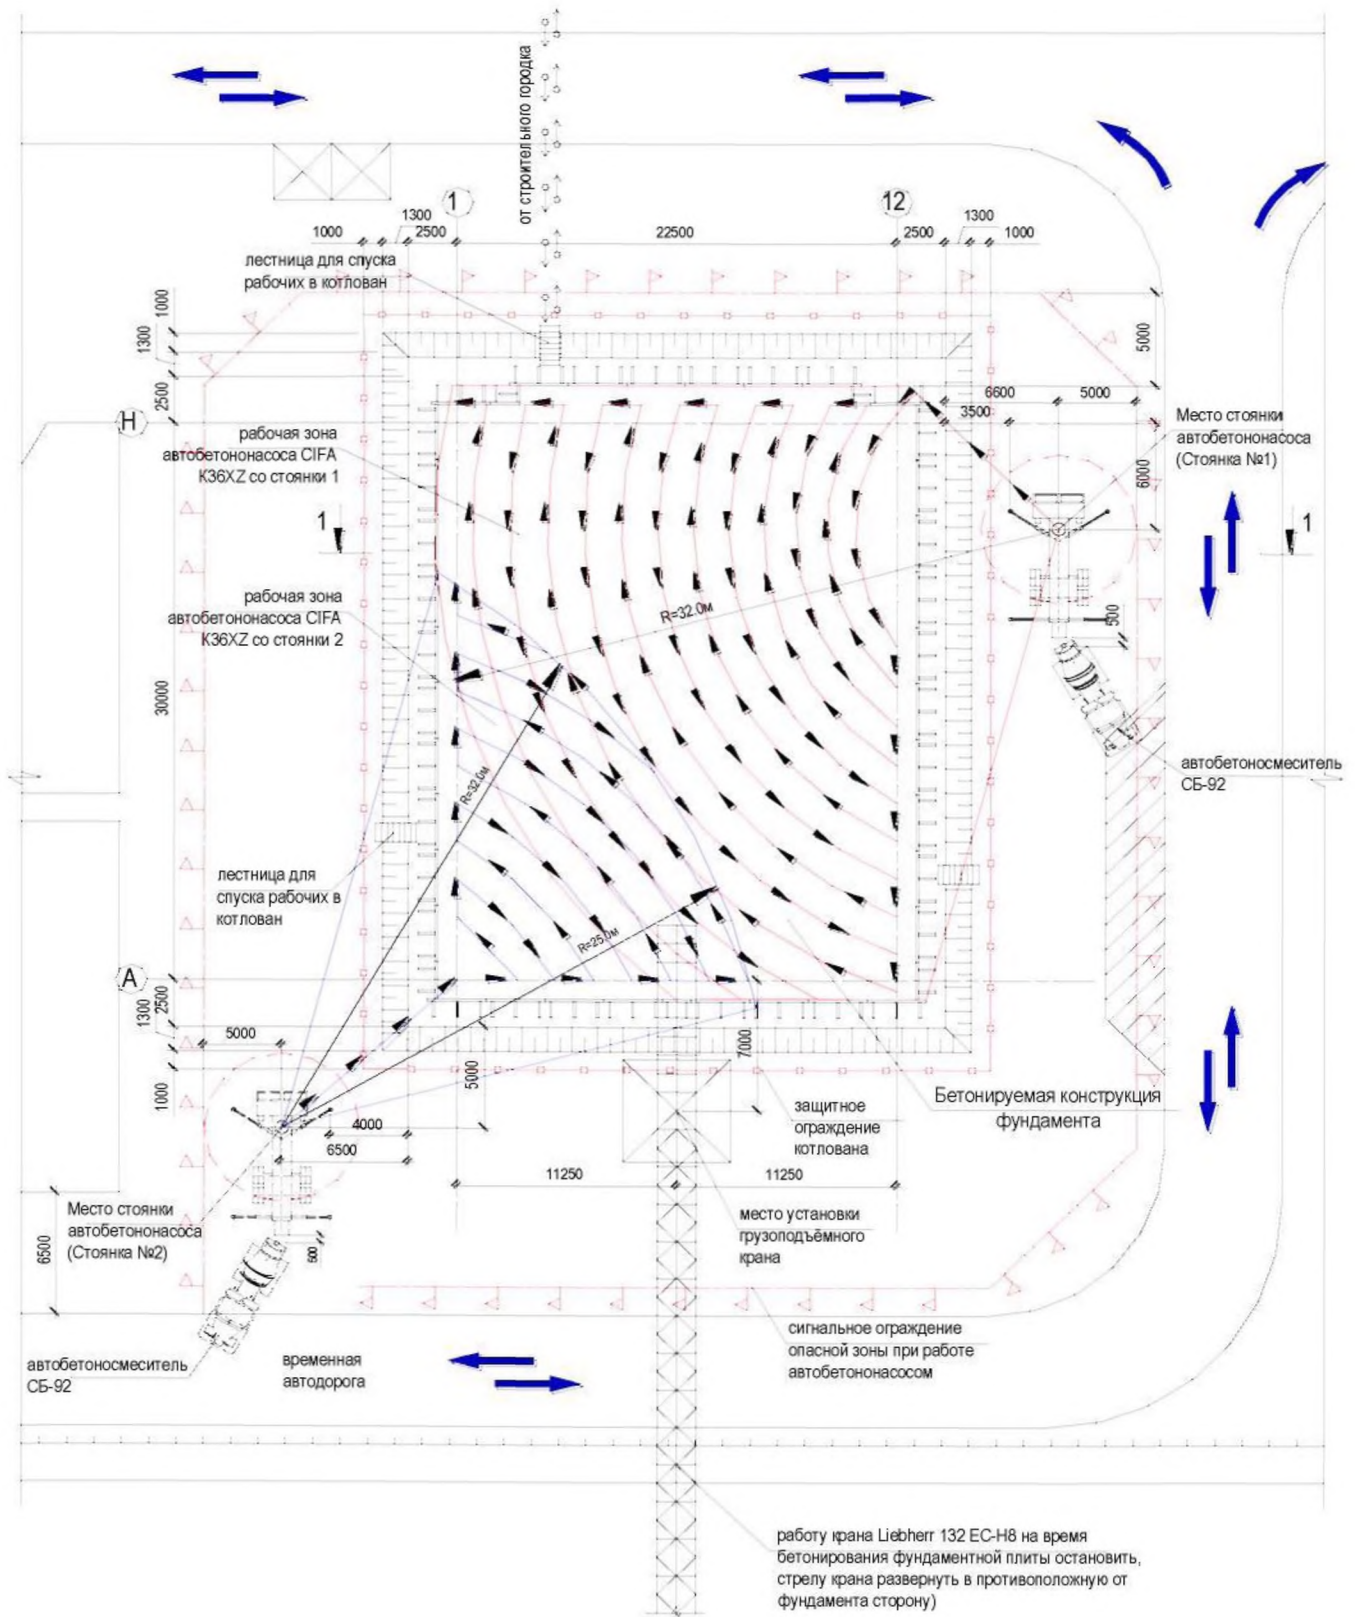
Схема производства работ по бетонированию фундаментной плиты
